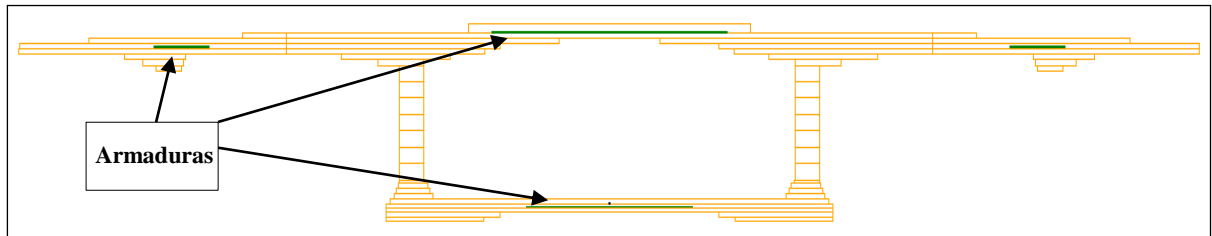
Representação das armaduras no tabuleiro (P22-P23).
